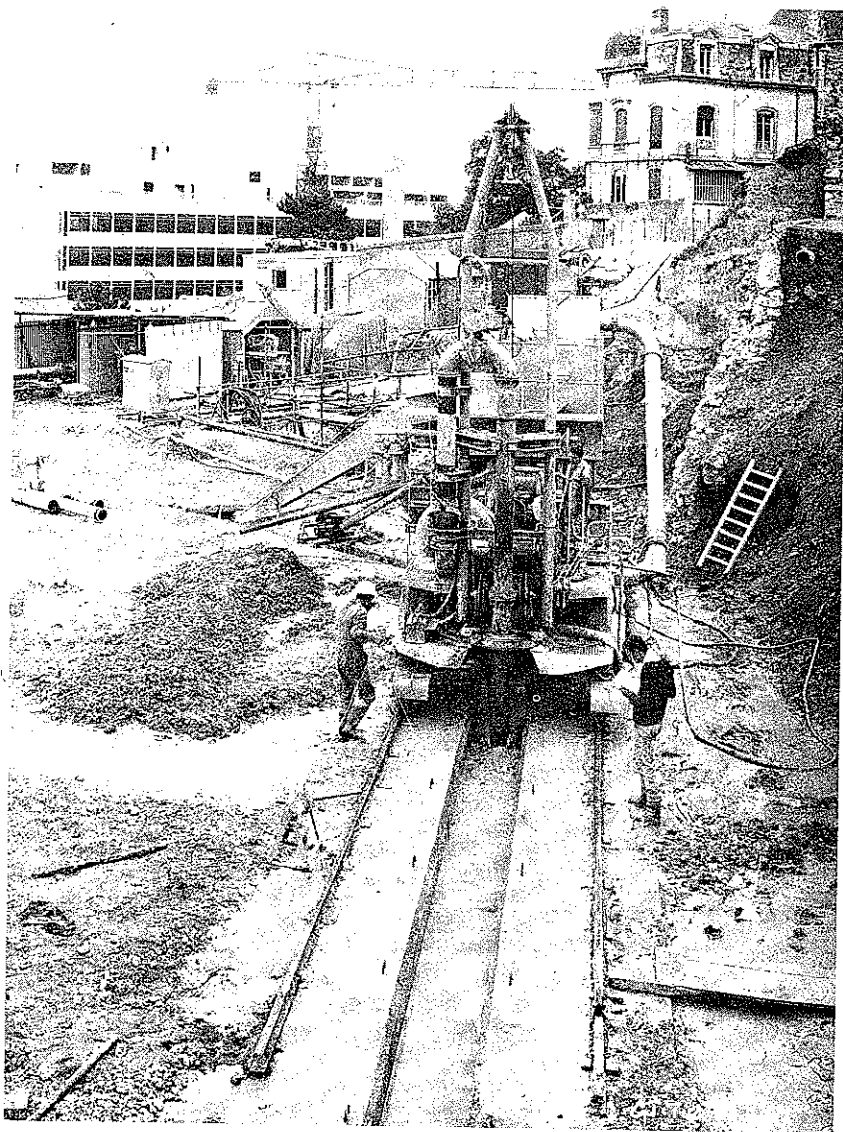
a. — Excavation de la paroi moulée du tunnel de Fourvière (Solétanche). On distingue très nettement les murettes-guides. Photographie : Studio Villeurbannais.
